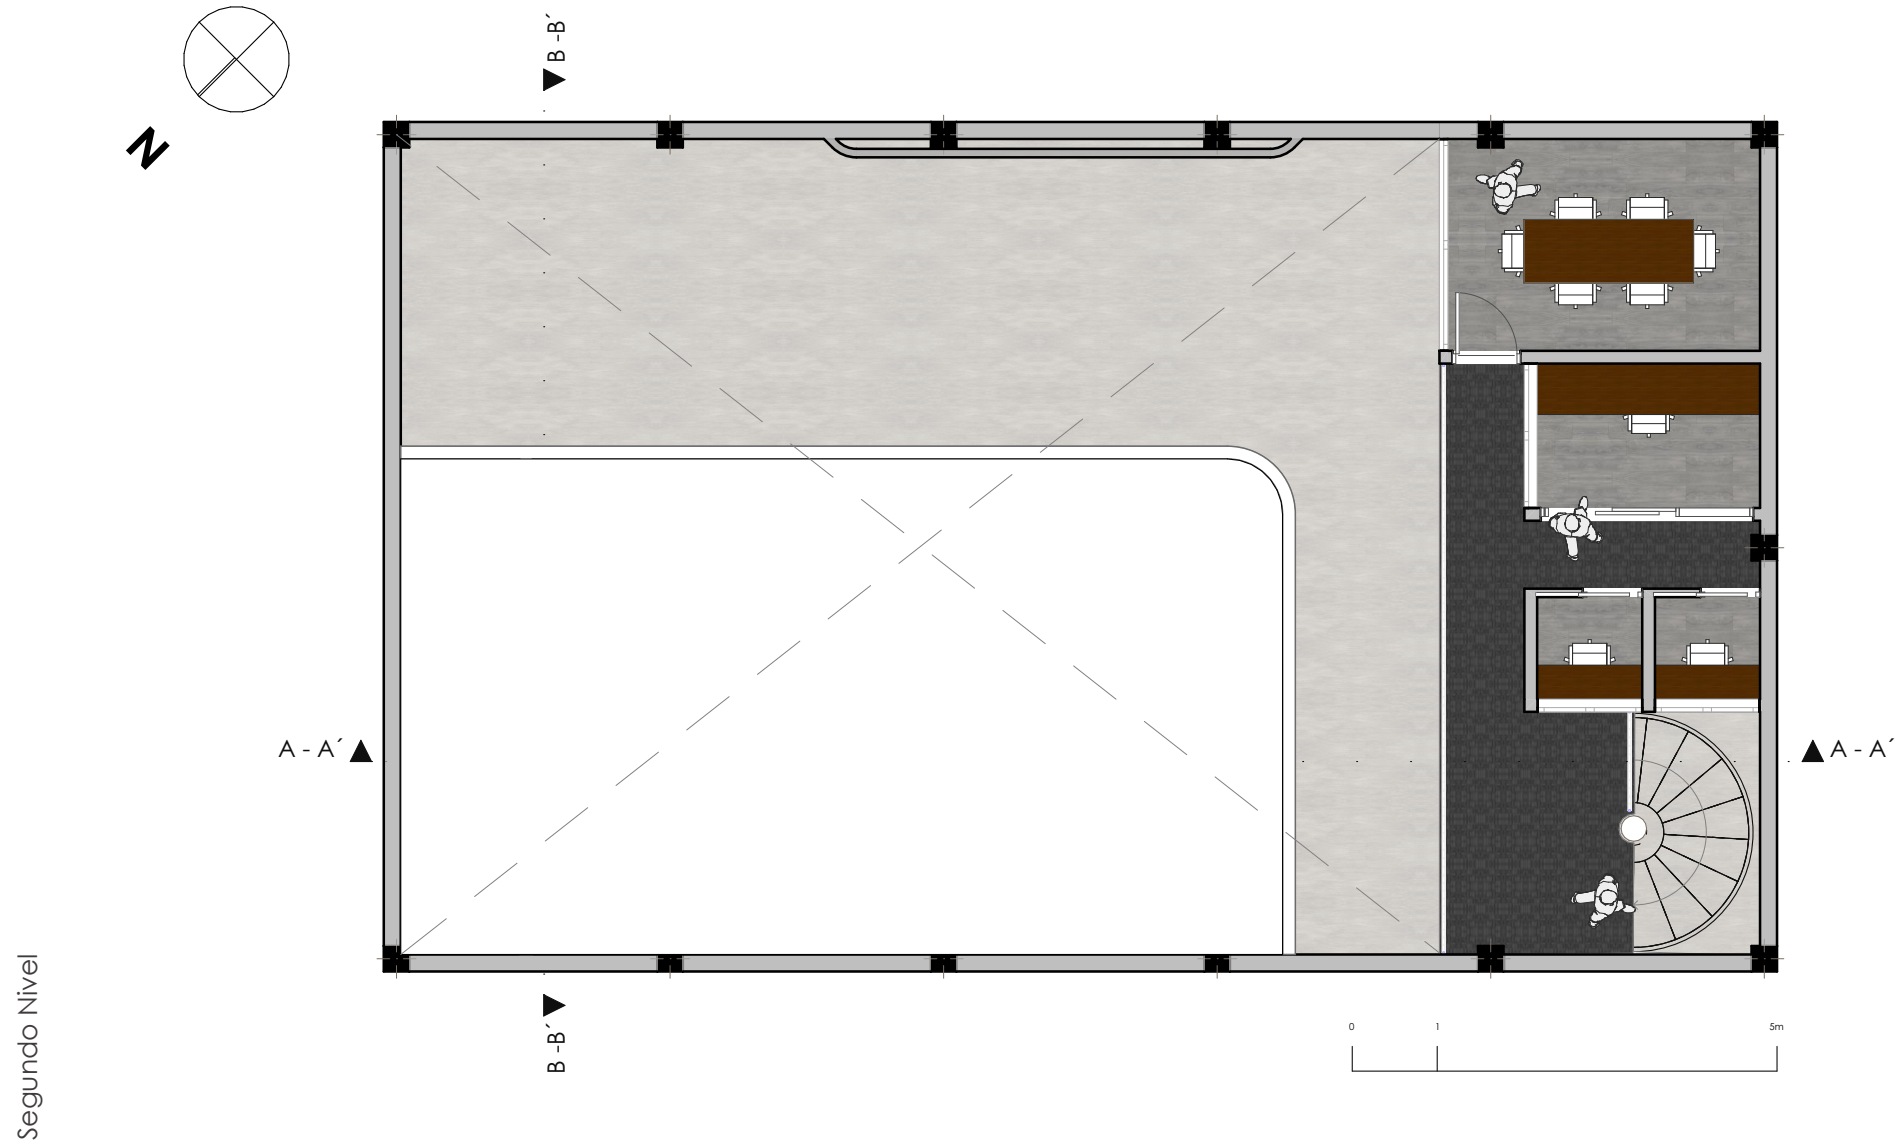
, Planta Arquitectónica Amoblada Planta Alta, Elaboración Propia.
